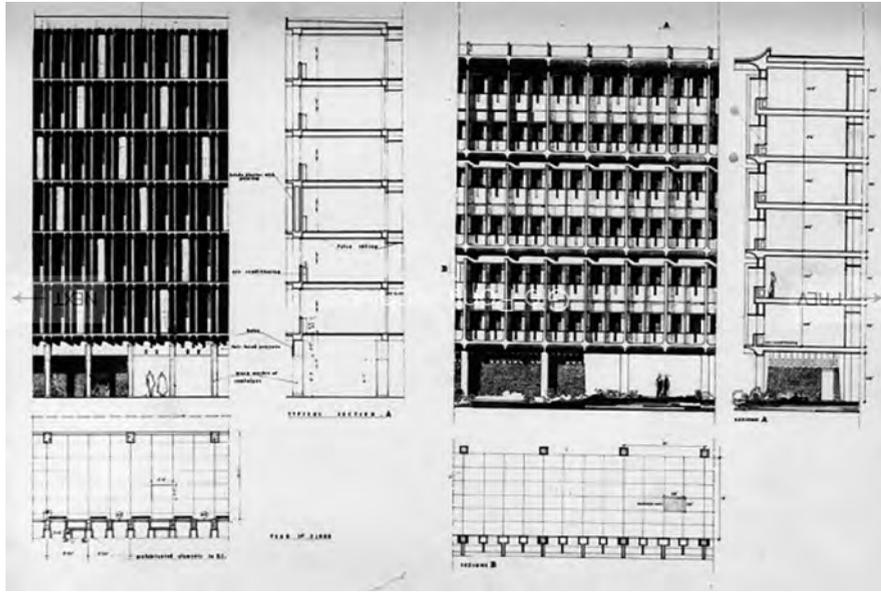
Gio Ponti, Palacio de los Ministerios, 1962, fachada + detalle de cortasoles
